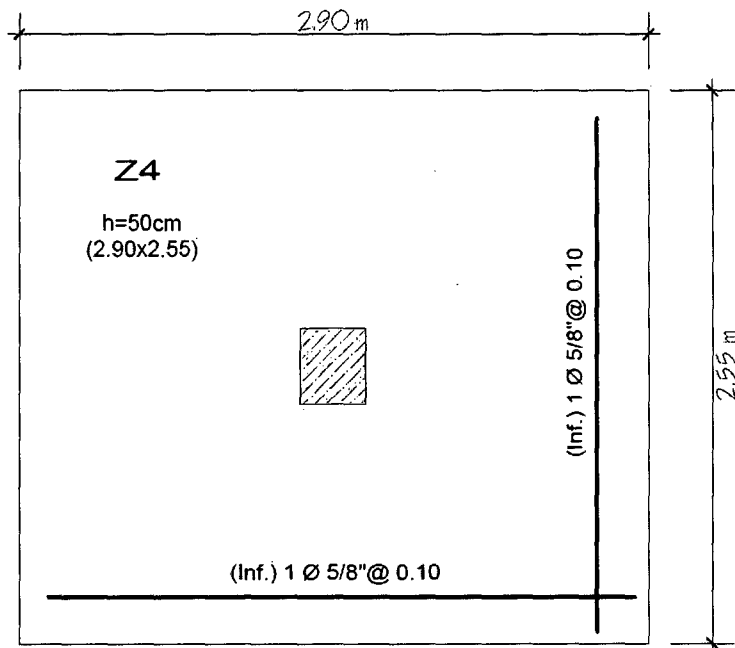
Distribución final del refuerzo para zapata Z-4.
